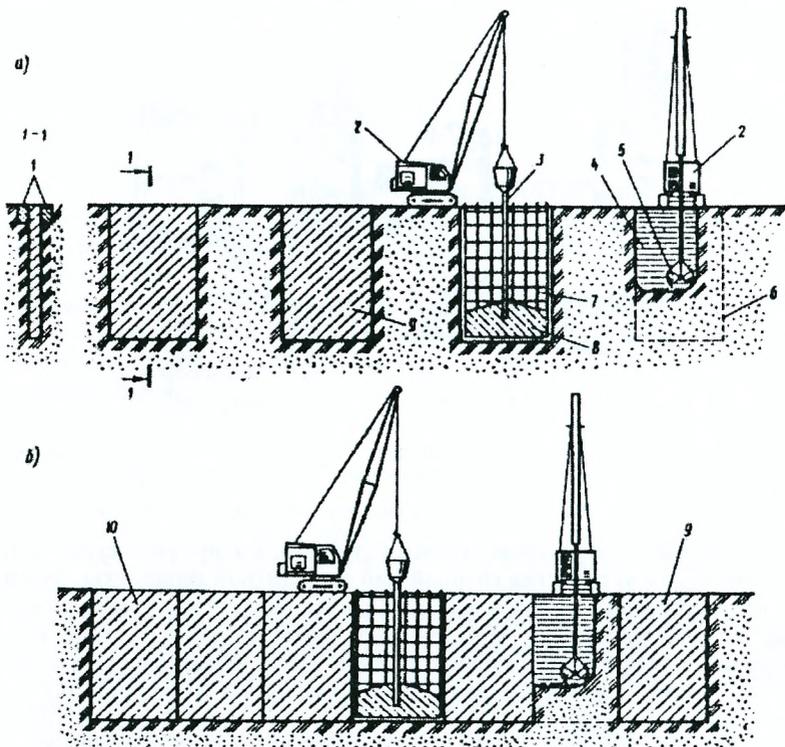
Конструкции, сооружаемые способом «стены в грунте»
